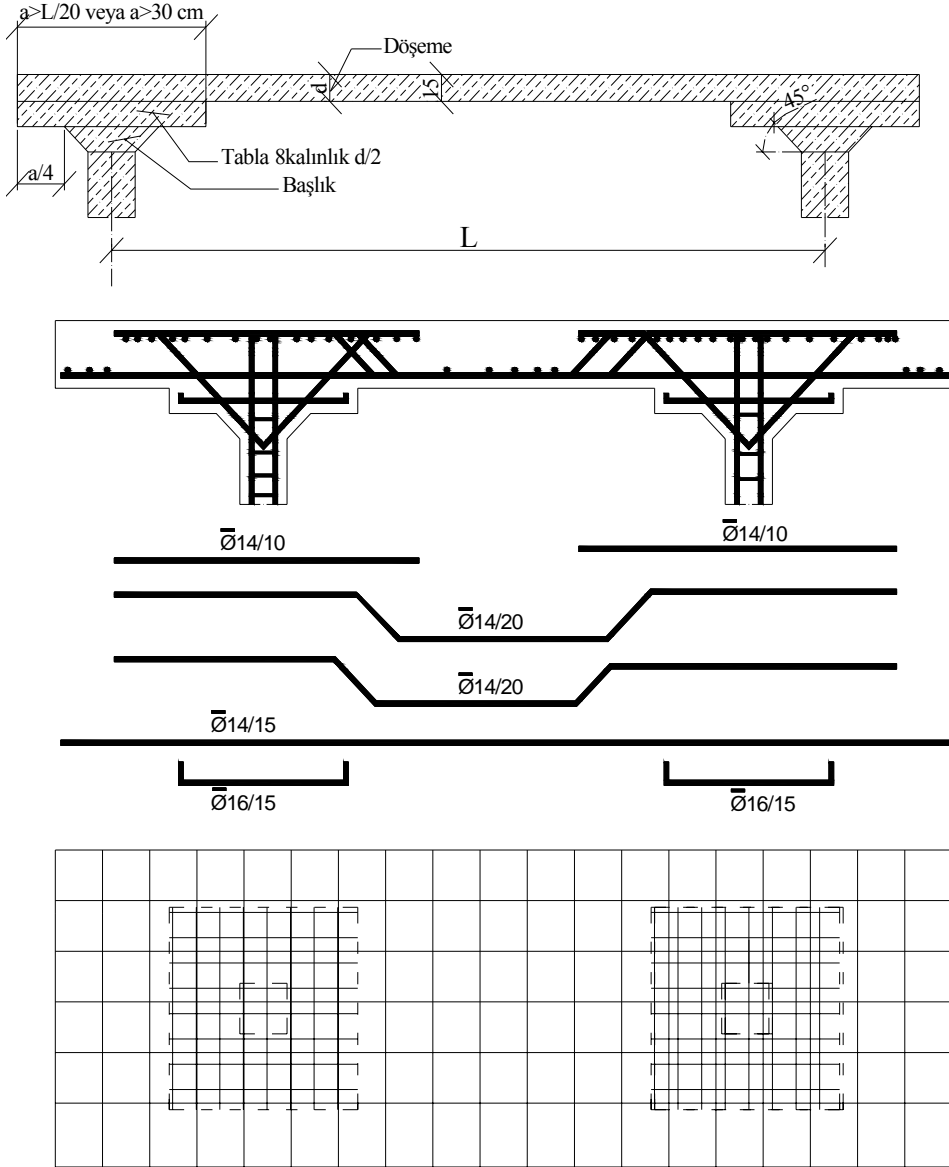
Devam eden döşemede, boy kesit, en kesit, plan ve çelik donatısı ölçek1/50
